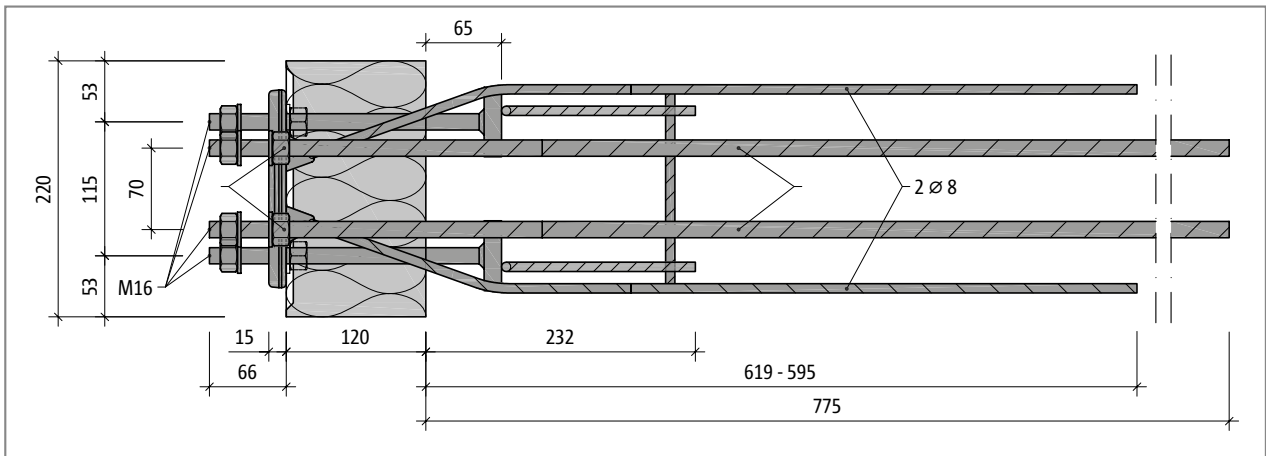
Schöck Isokorb® Typ KSXT14-V8: Grundriss
